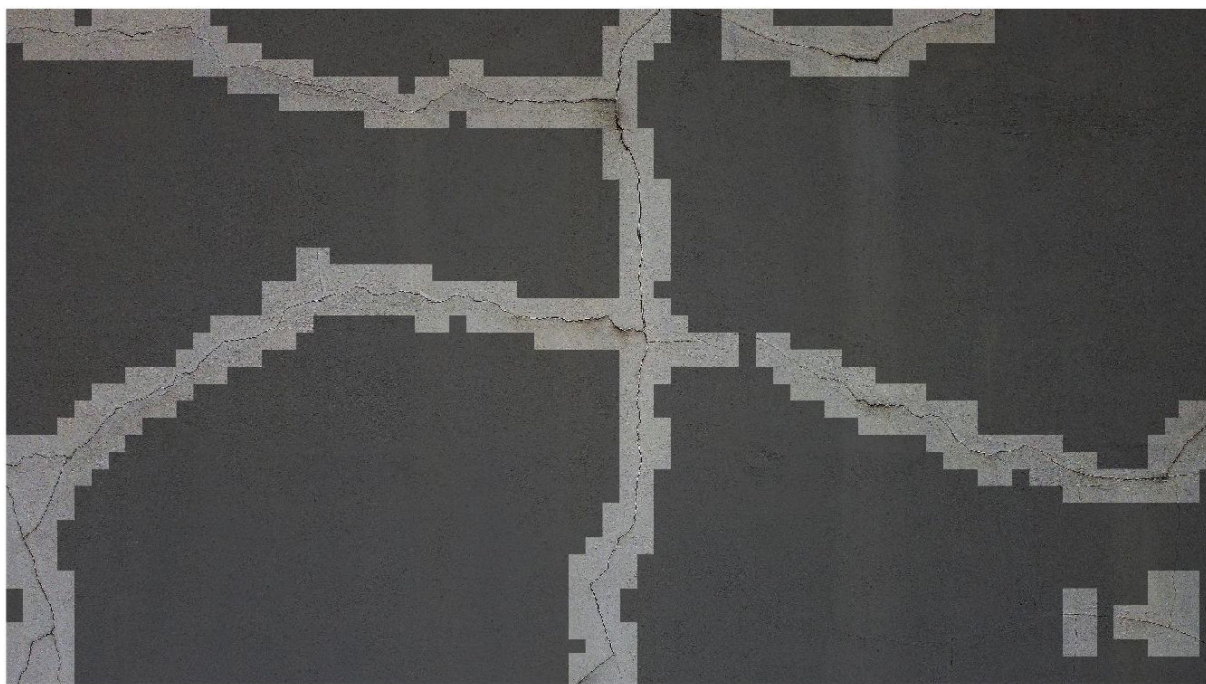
Detecção Fissura Z.F.14
